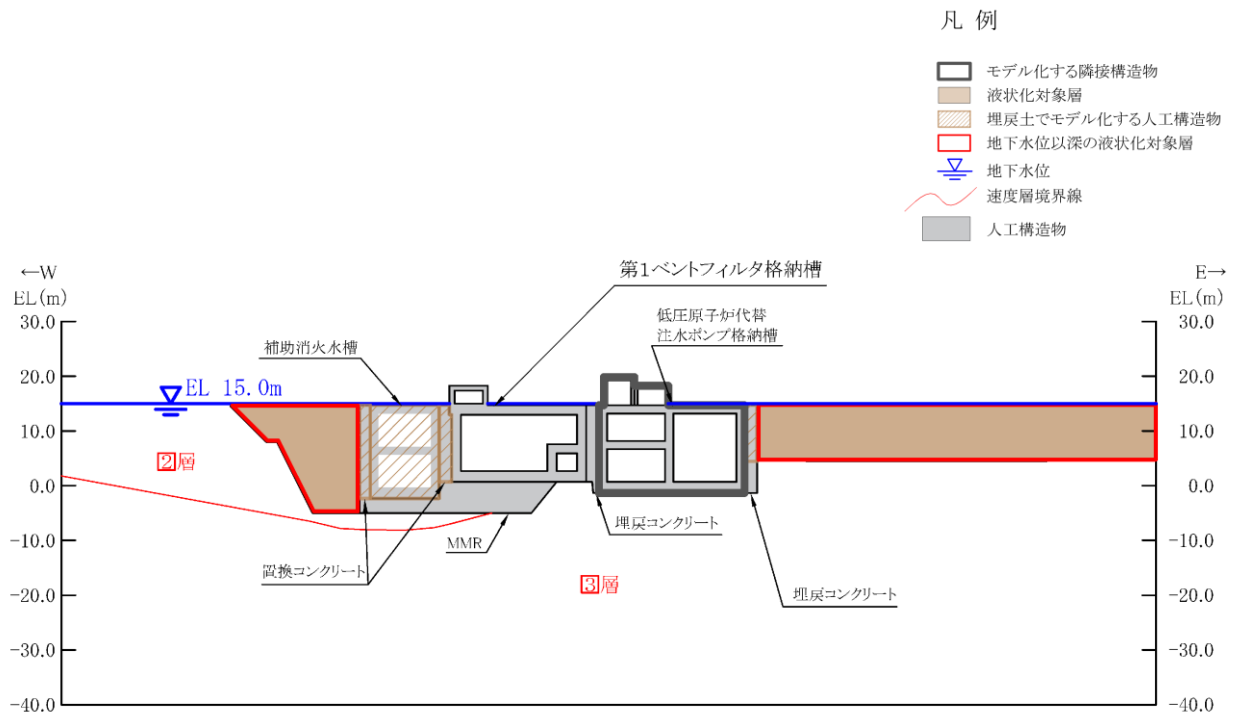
第 1 ベントフィルタ格納槽 評価対象断面図 (C-C 断面位置)
